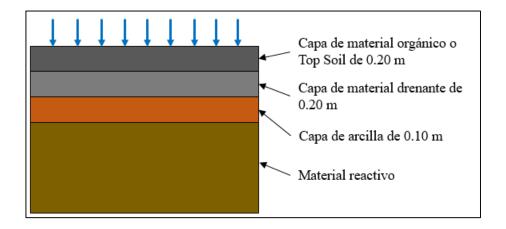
Cobertura Tipo III, para cierre de Planta Concentradora.
